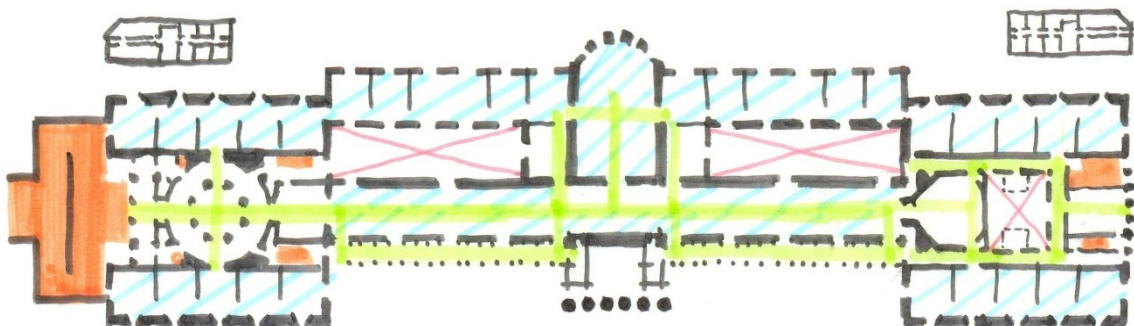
Planta do pavimento térreo do Edifício de Villanueva (1785). Croqui elaborado por Ivan Portero da Silva (USJT, 2011).
